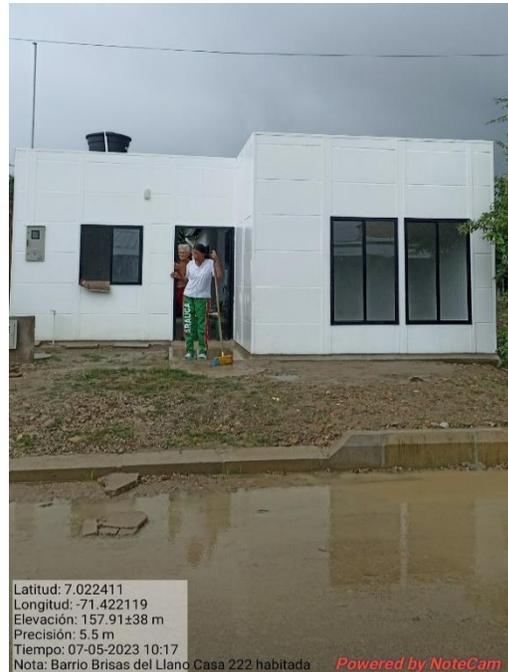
CASA 222 BARRIO BRISAS DEL LLANO.
